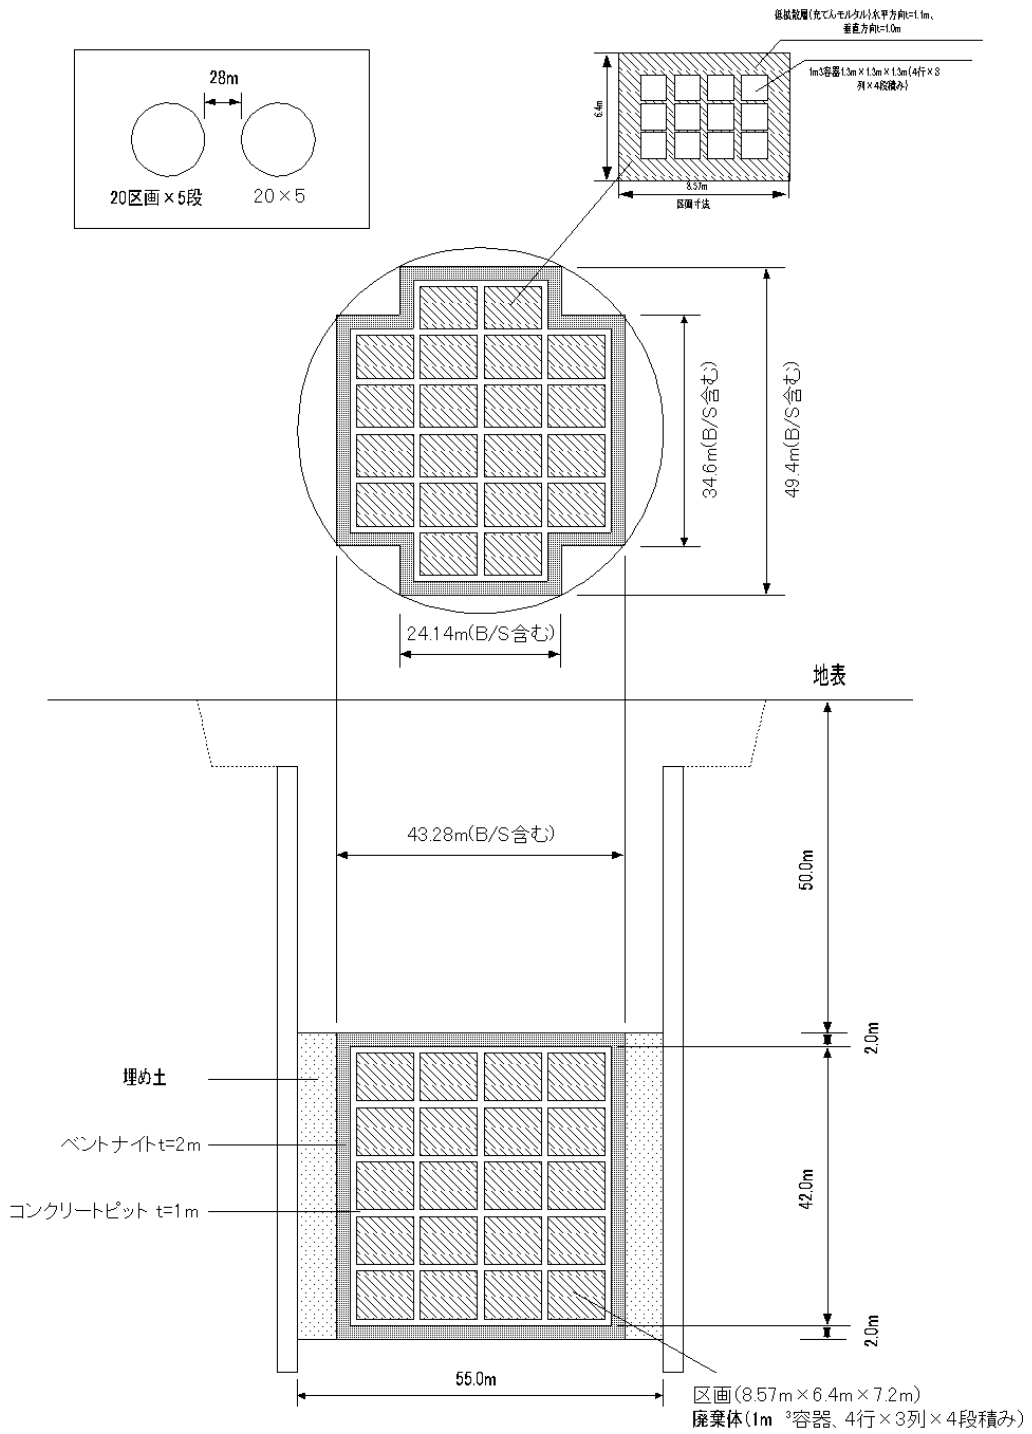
ケース2(新設)の開削サイロ型施設配置図
